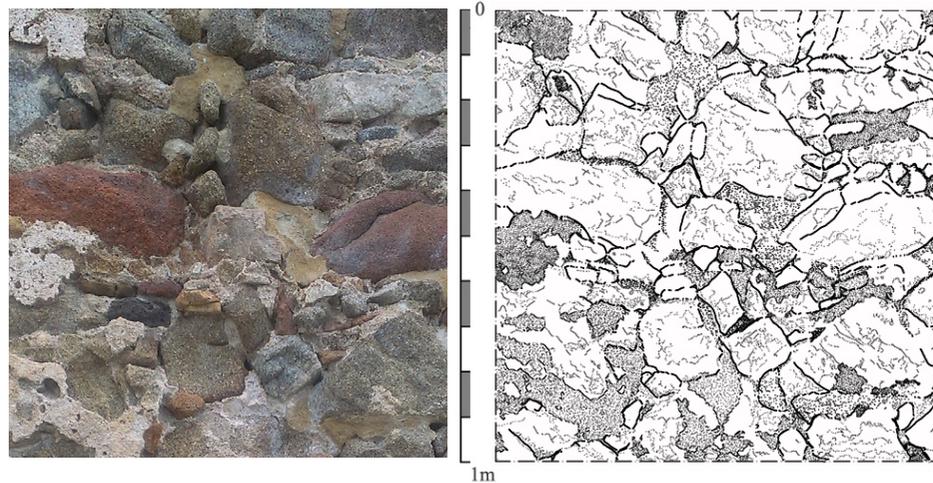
Campione murario. Fotoraddrizzamento e rilievo architettonico.
